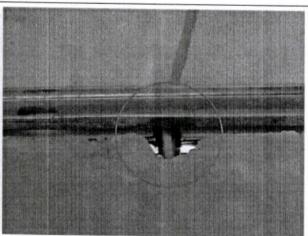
Fisuras reparadas en losas.
